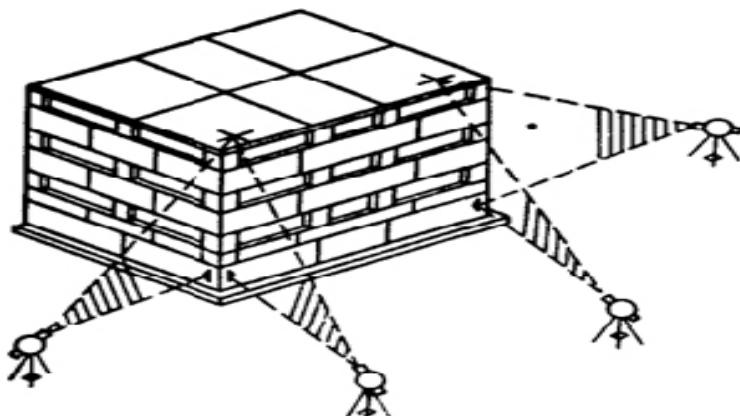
Схема похилого переносу осей з цоколя будівлі на монтажний горизонт
